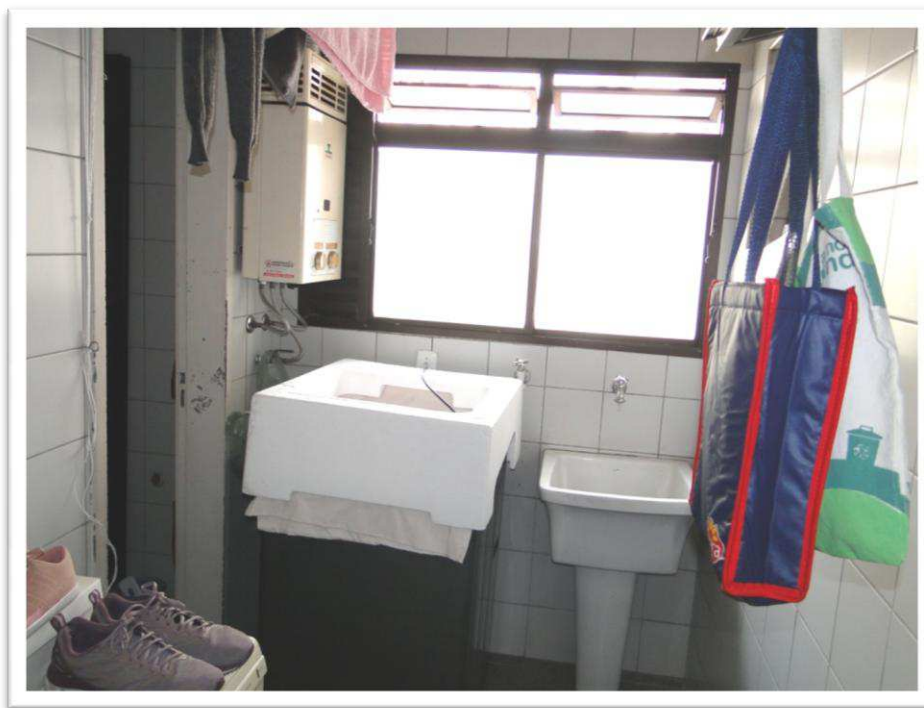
Vista da área de serviço do apartamento avaliando.
